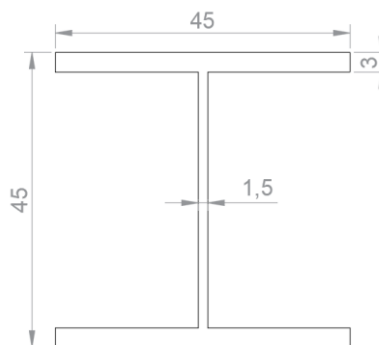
Section initiale des poutres principales // © bordas+peiro
